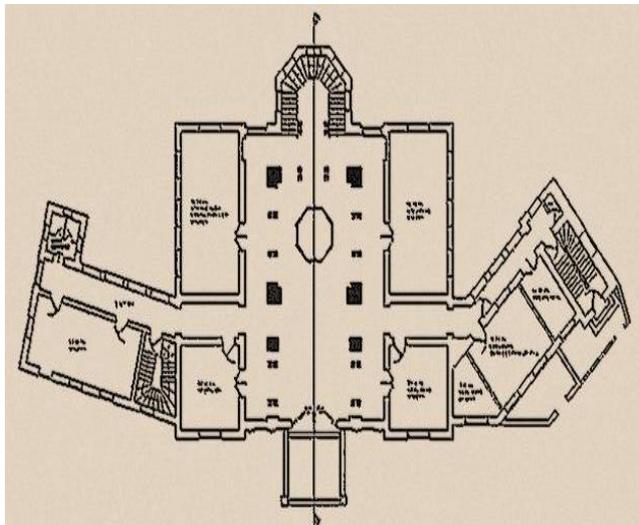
Plan rez-de-chaussée de la medersa de Constantine. (Source: www.google.dz/images(2013))
